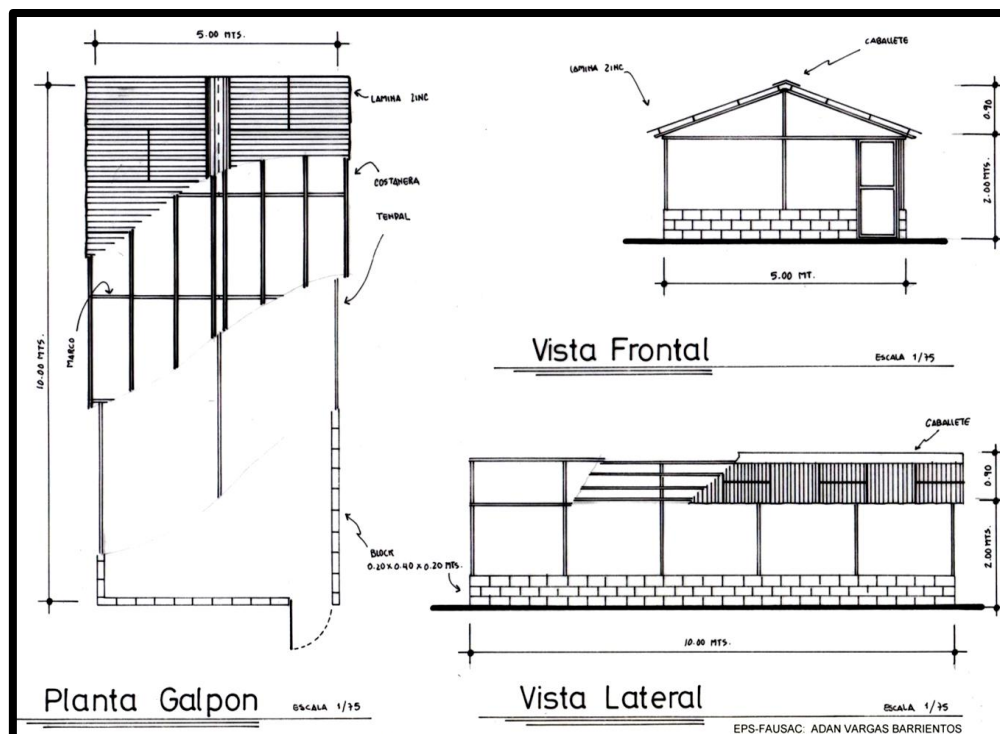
Plano que muestra la planta del galpón, vista frontal y lateral.
